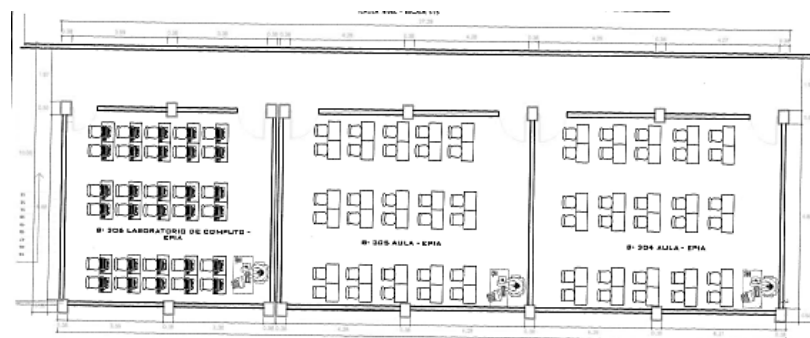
Plano de Distribución de la Primera Sección de aulas y Laboratorios
